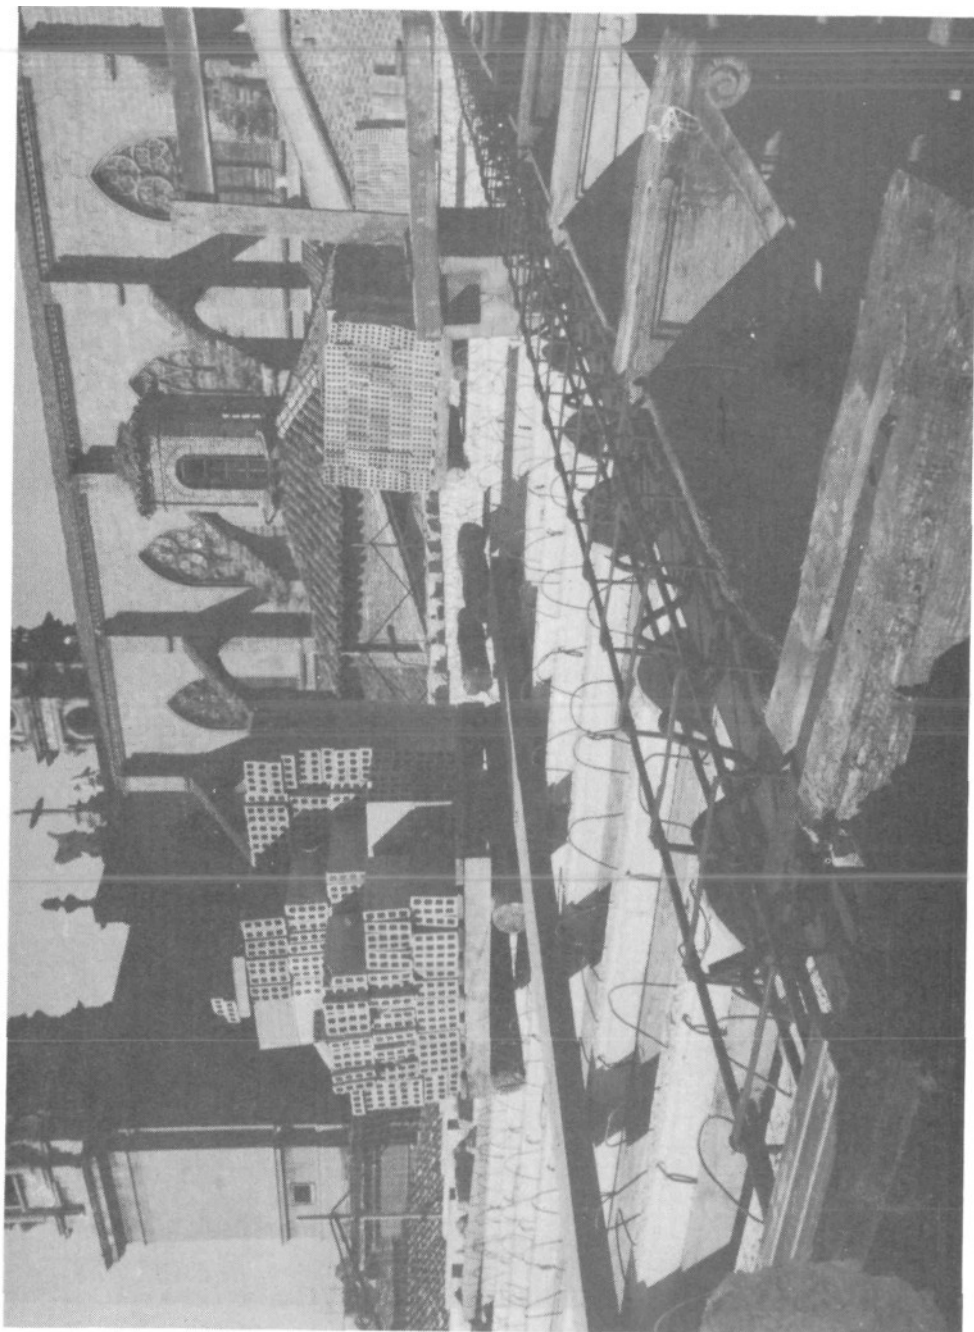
Detalle de la construcción de la nueva cubierta. La jácena de hierro, ya colocada, soporta el forjado de hormigón y el alero de madera.
